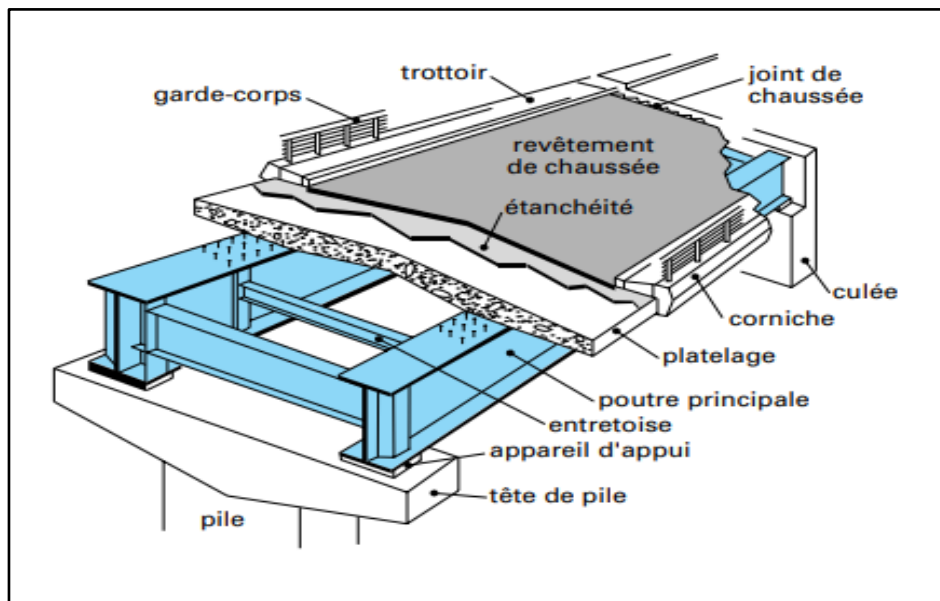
Éléments constitutifs d'un pont à poutres métalliques .
